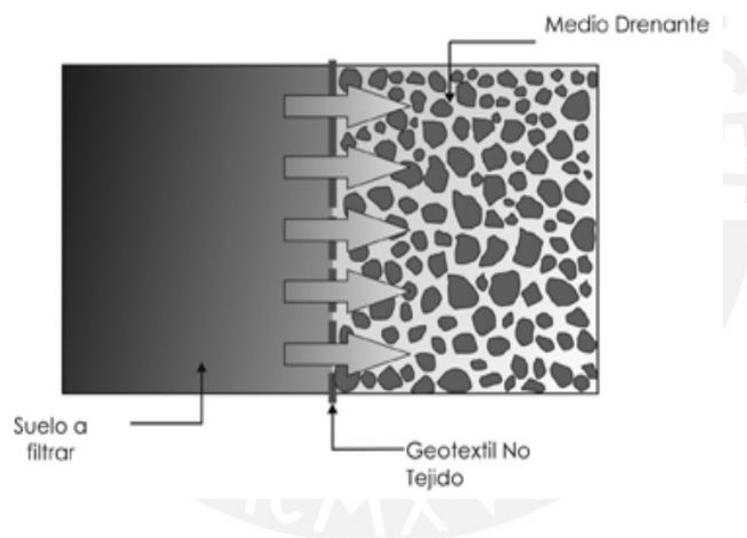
Sistema de drenaje con geotextiles no tejidos.
